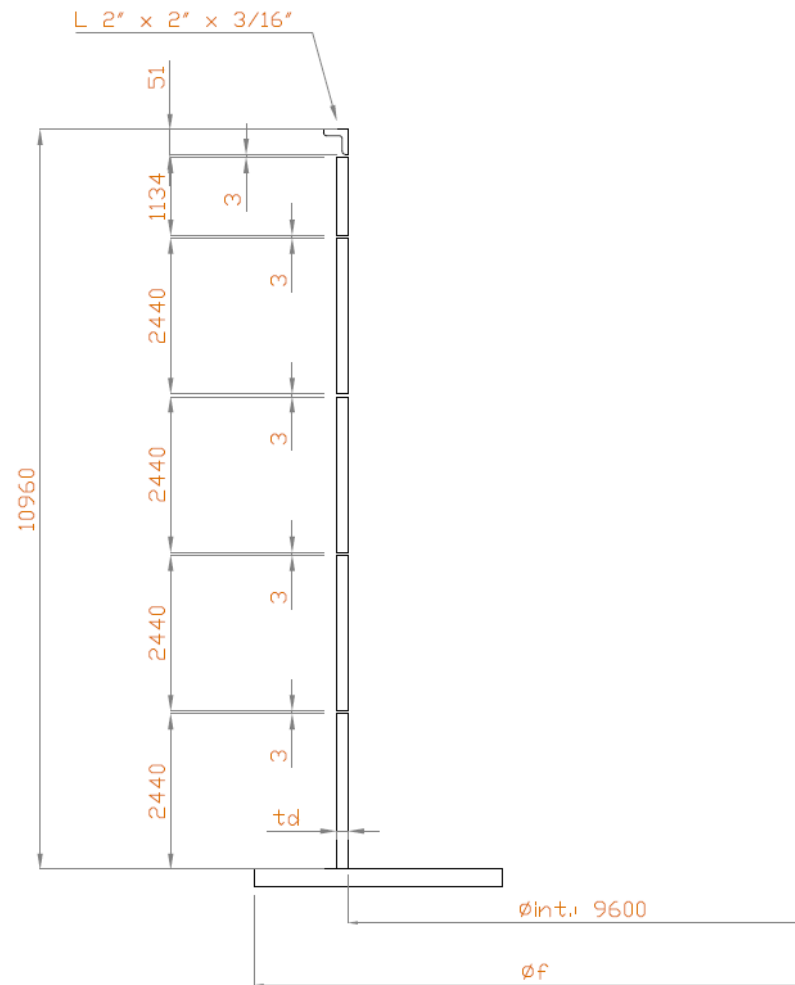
Esquema del cuerpo con ancho de plancha 2440 mm
